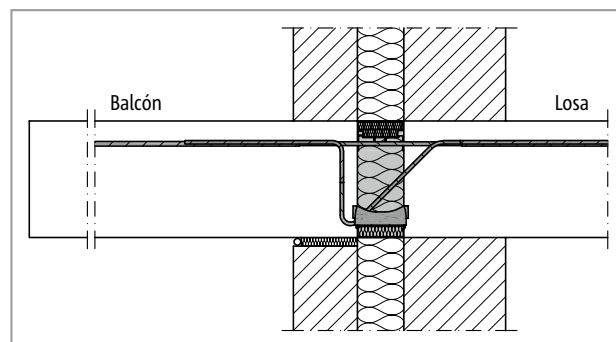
Schöck Isokorb® T tipo K: Conexión para muro doble con núcleo aislante
